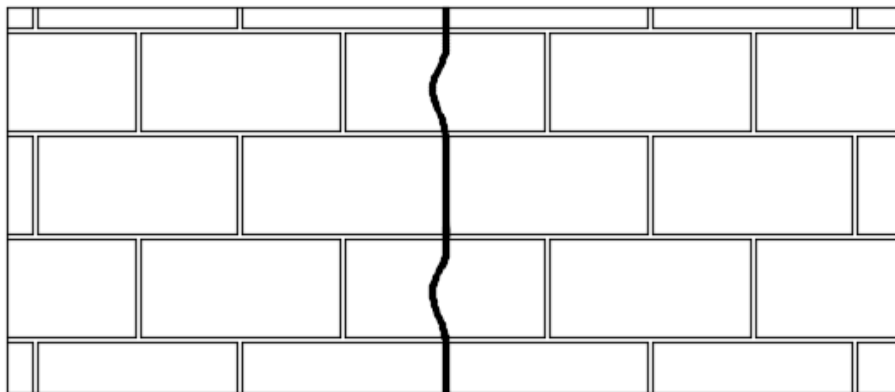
Configuração típica de fissura geométrica nos blocos da alvenaria.
